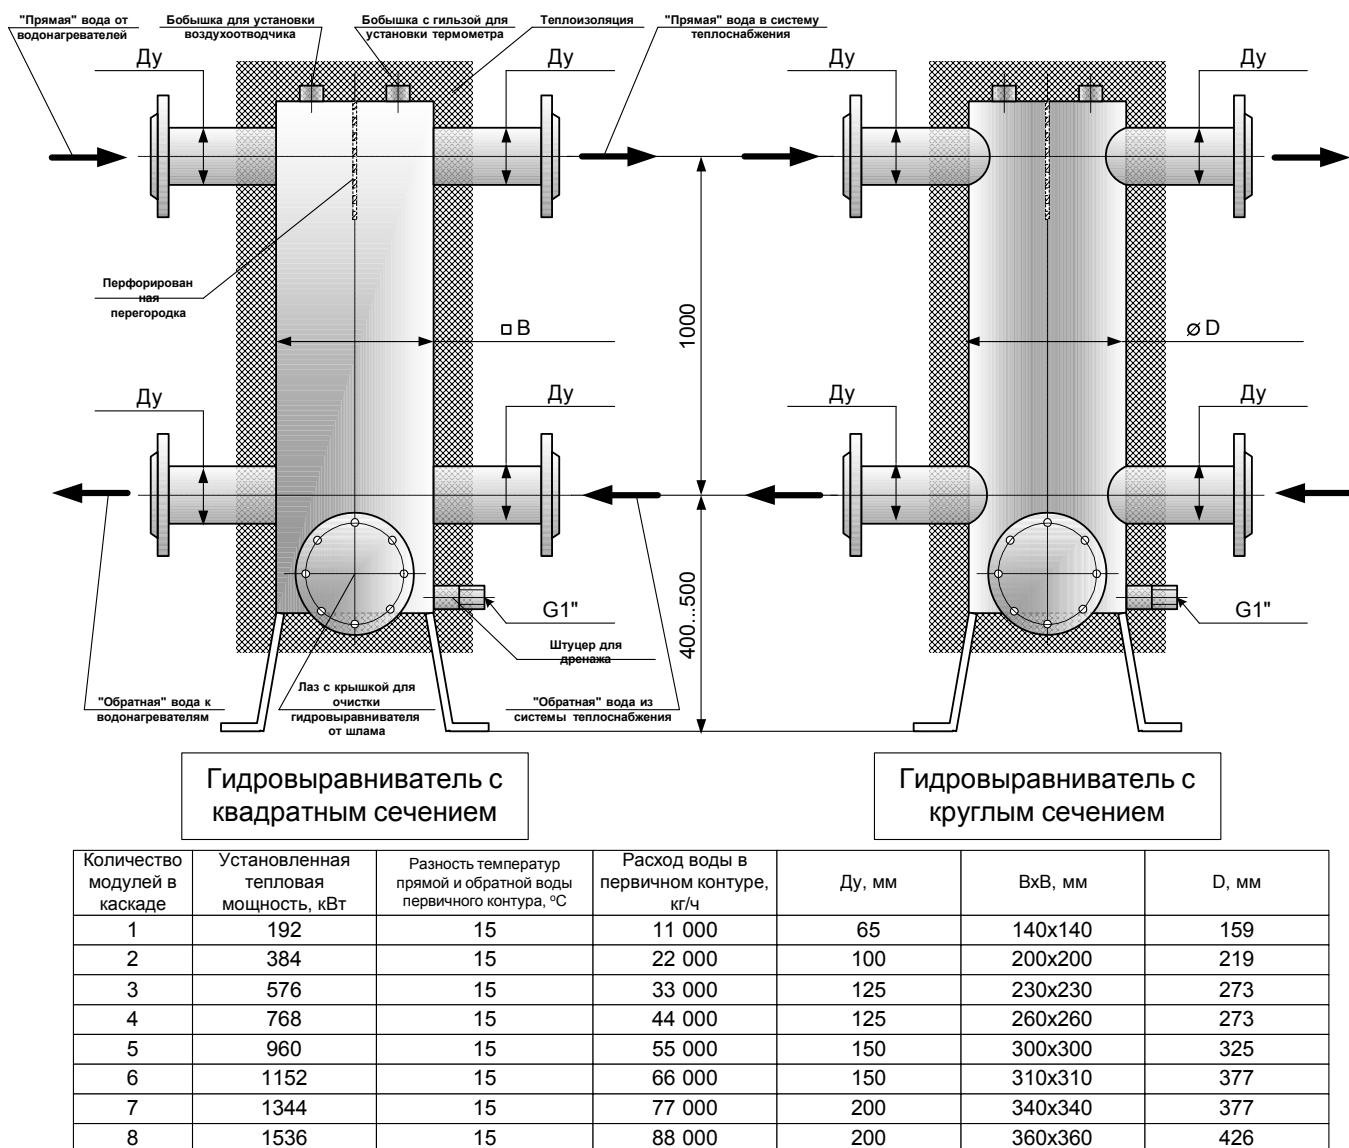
Устройство и размеры гидроуравнителя
